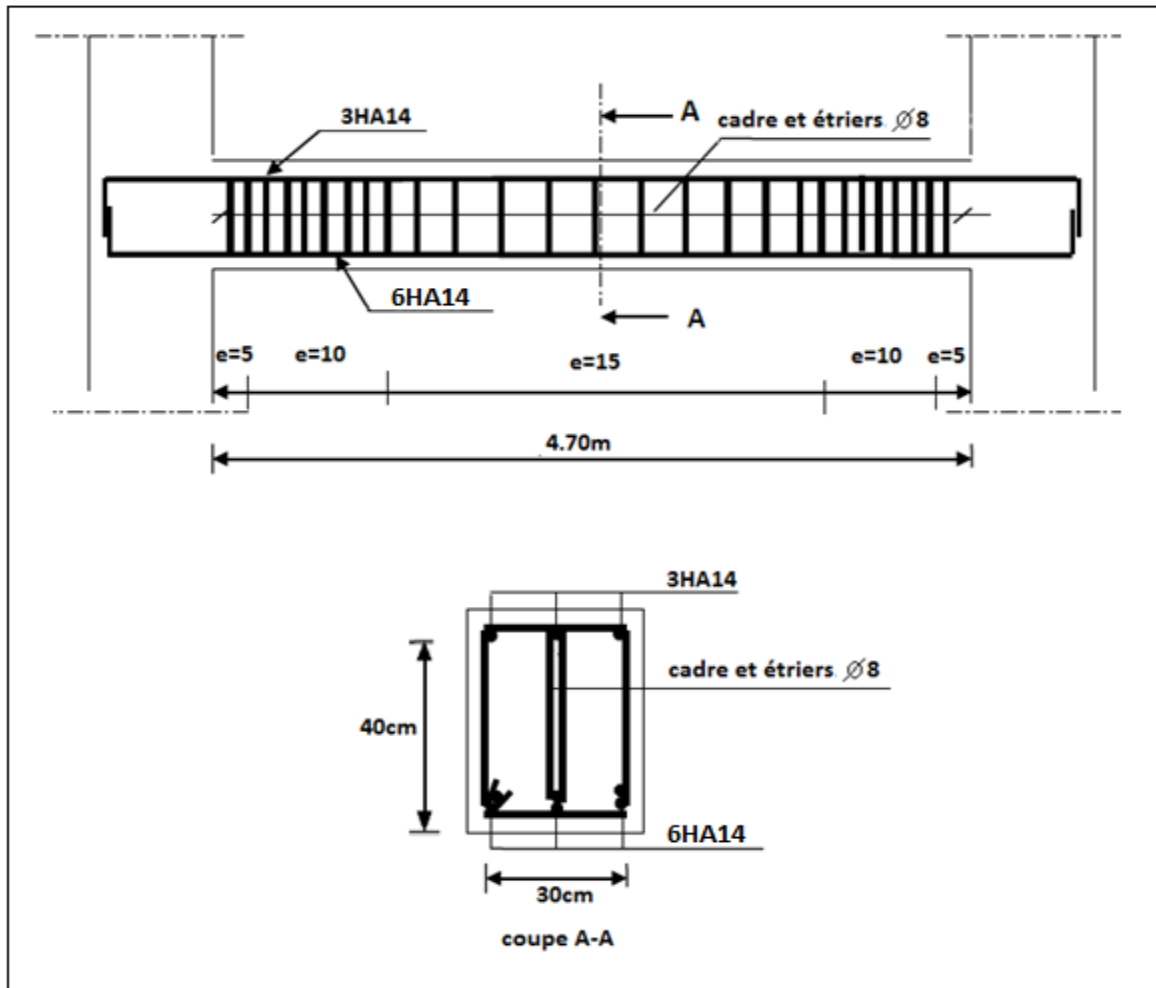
Plan de ferrailage de la poutre palière.
